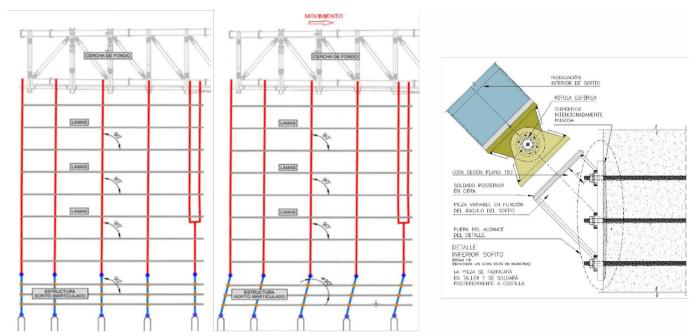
Izquierda: Esquema de desplazamientos de fachadas N-S en dirección E-O. Derecha: Conexiones tipo puntal sofito a pantallas hormigón.
